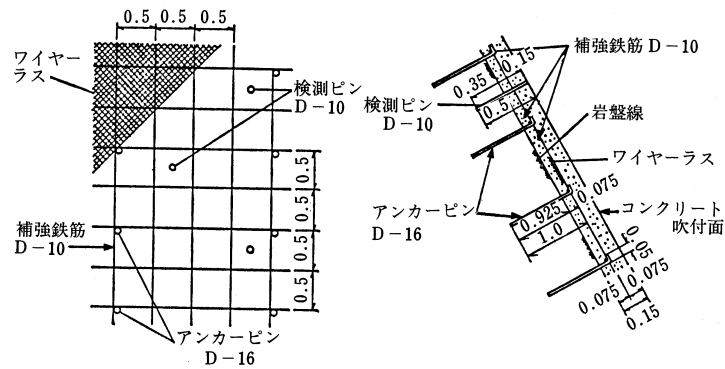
コンクリート吹付工の一例 (単位: m)
